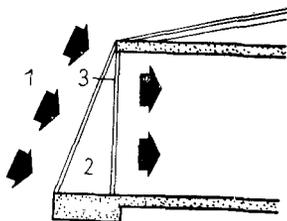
Система пассивного солнечного обогрева (Вагнер)
